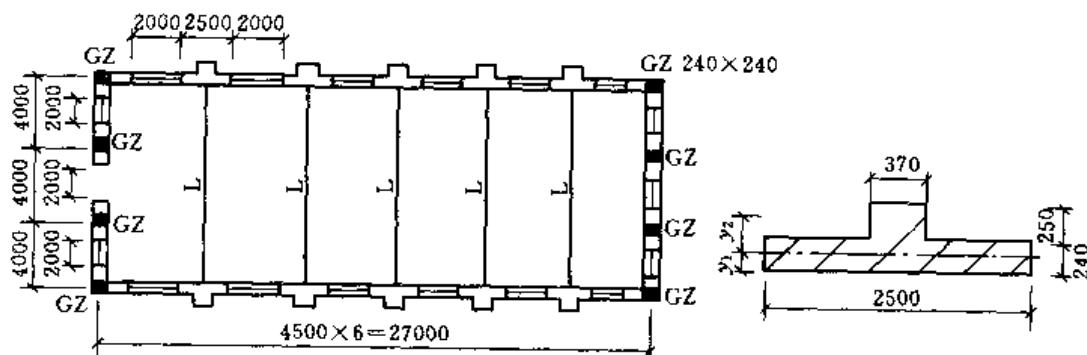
装配式无檩体系屋盖平面布置图 (单位: mm)
